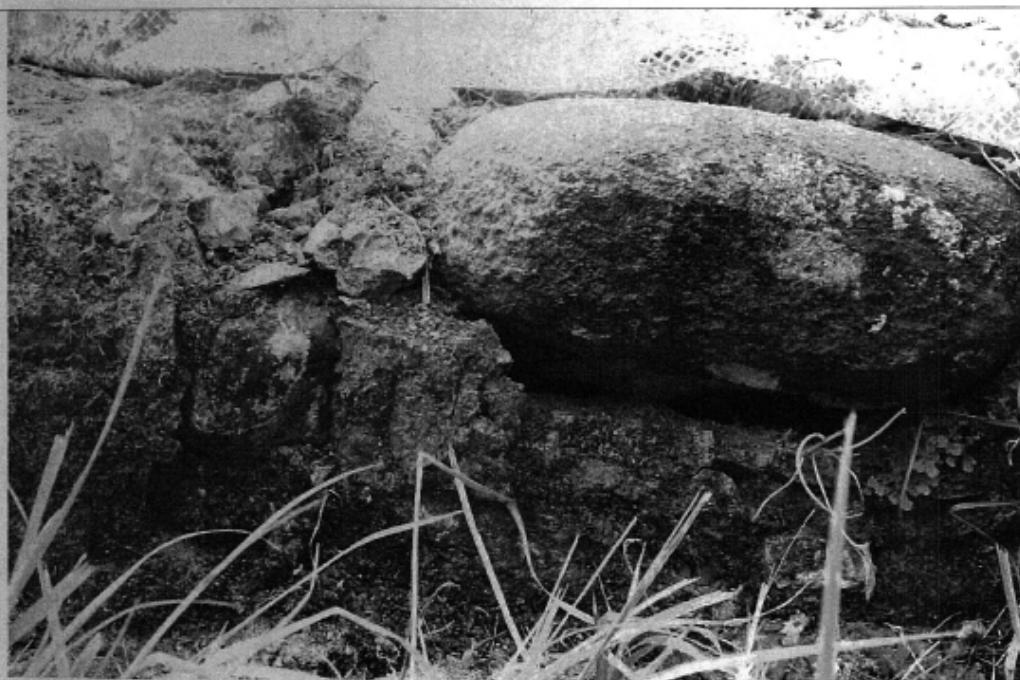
Relikty kościoła w Warzymicach. Fragment ściany południowej z wejściem do kościoła. W głębi zdjęcia wał ziemny przykryty zabezpieczeniem z plandeki. Najlepiej zachowany fragment murów.
